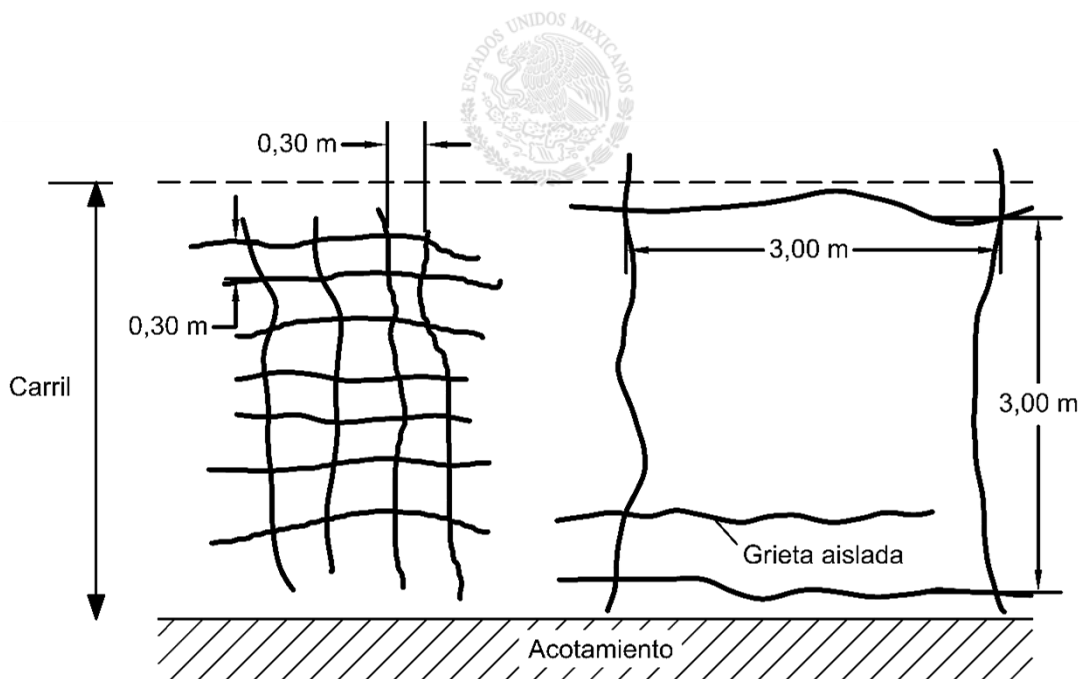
Esquema del deterioro “agrietamiento en bloque” (vista en planta)
